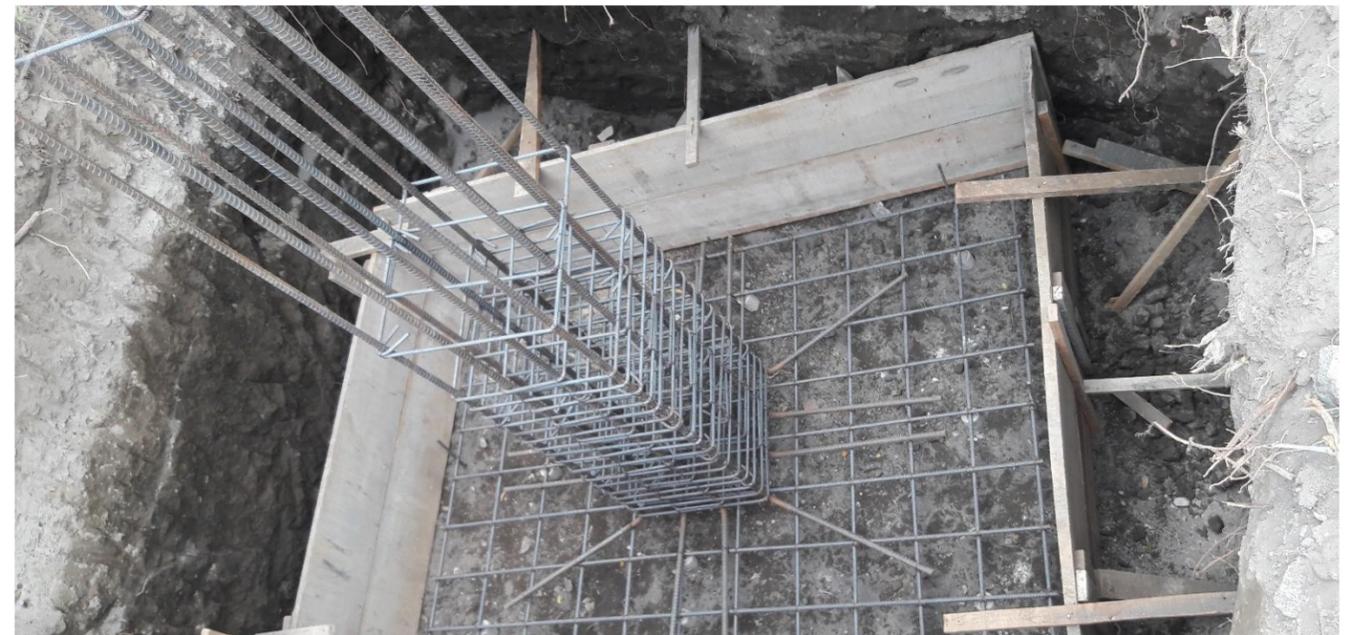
Formaletas. Instalación de formaletas en zapata Z-1 Excavación con tubería de redes expuesta. Fuente: Autor.
